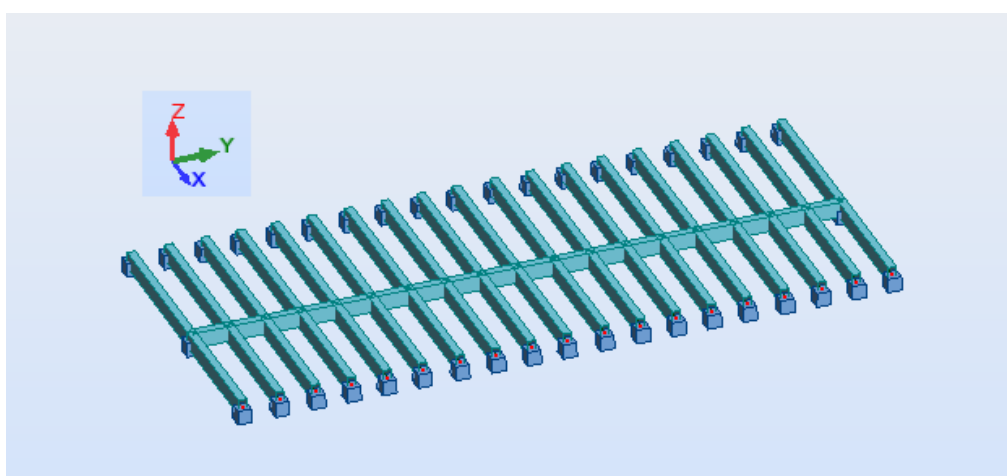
Aspeto do modelo do pavimento em estudo
